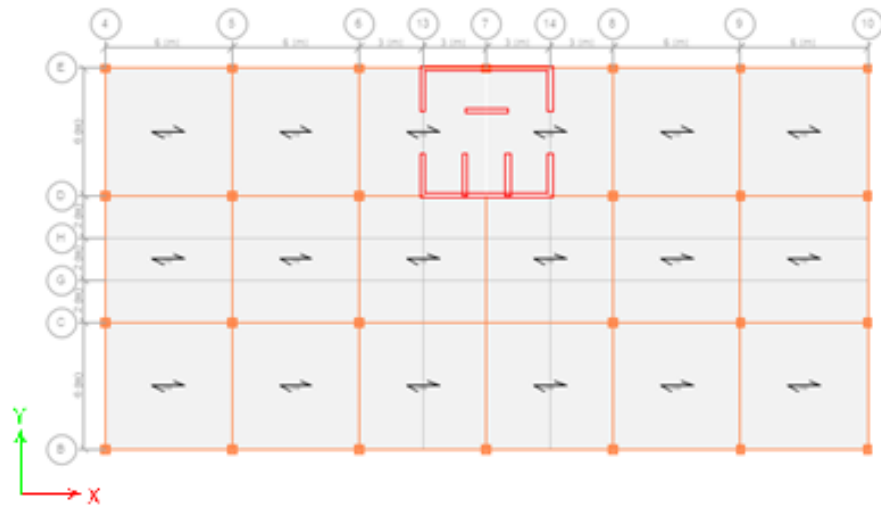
Planta del edificio con simetría,  $CA=CR$ .
